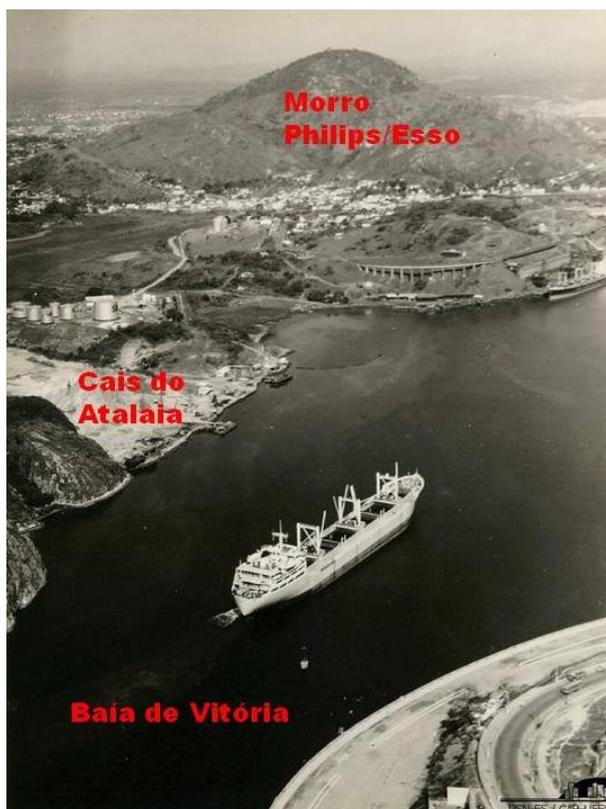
Foto área da Baía de Vitória com vista para o Cais do Atalaia e movimentos de terra para a construção do Porto de Capuaba em Vila Velha em 1961. Autor: Carlos Botelho. Fonte: Adaptado de Instituto Jones dos Santos Neves.
